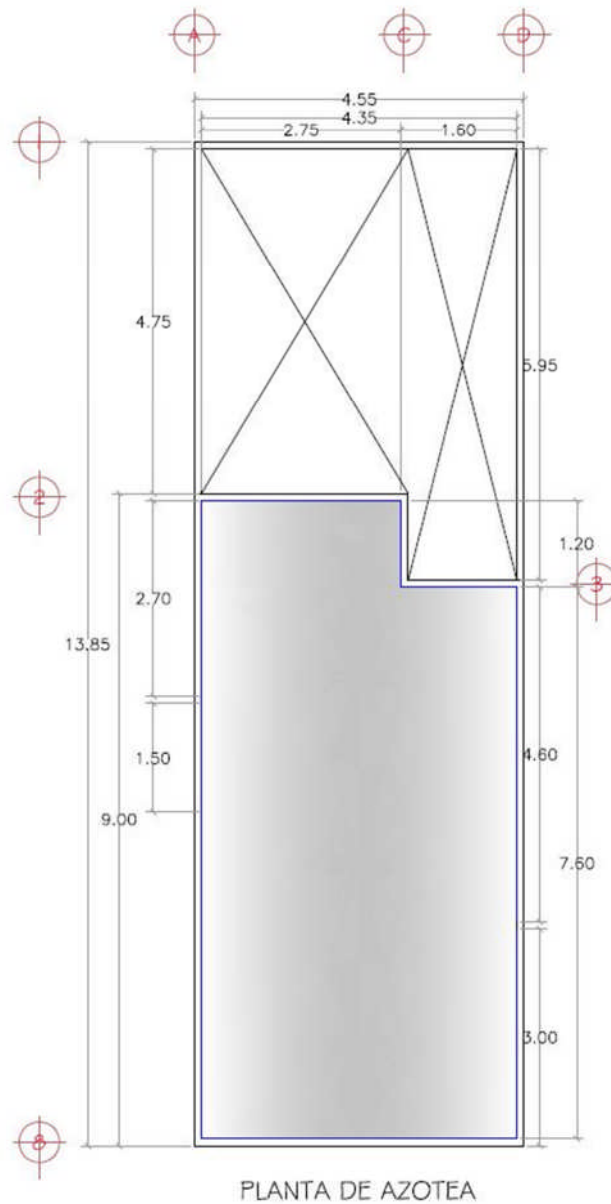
Planta de azotea del Fraccionamiento Porto Bello
